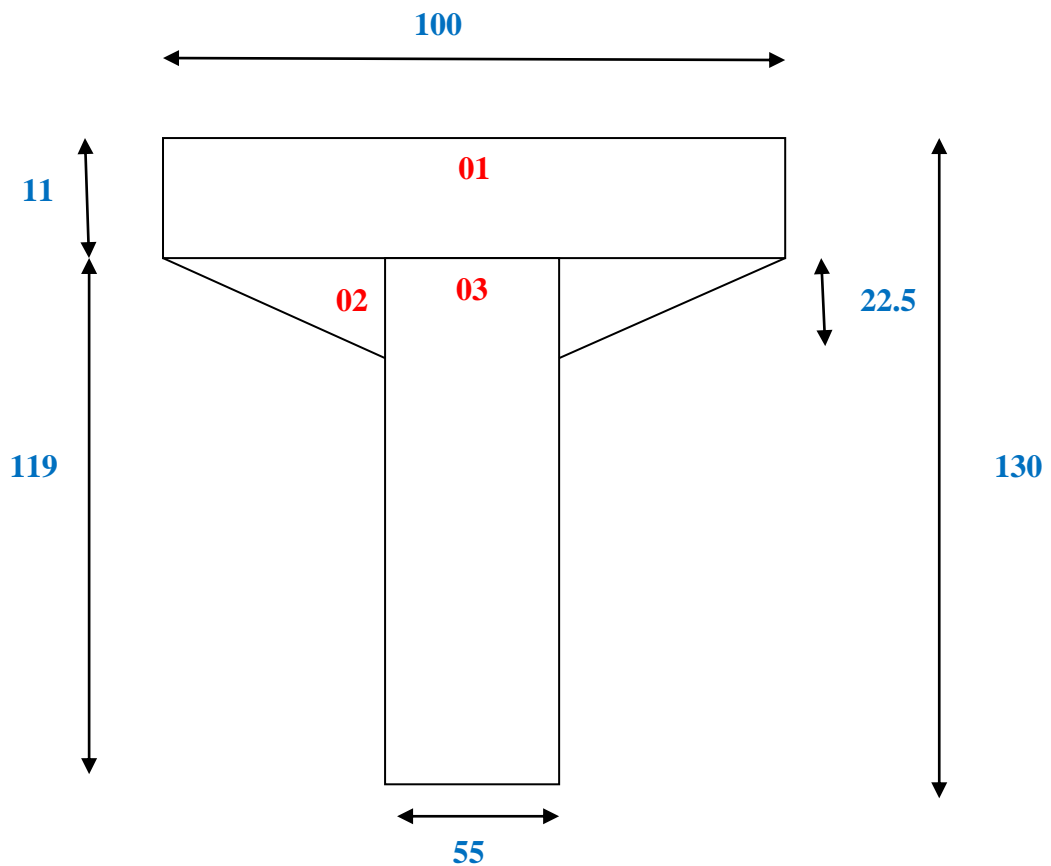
Dimensions de la poutre 'intermédiaire au niveau de l'appui.
